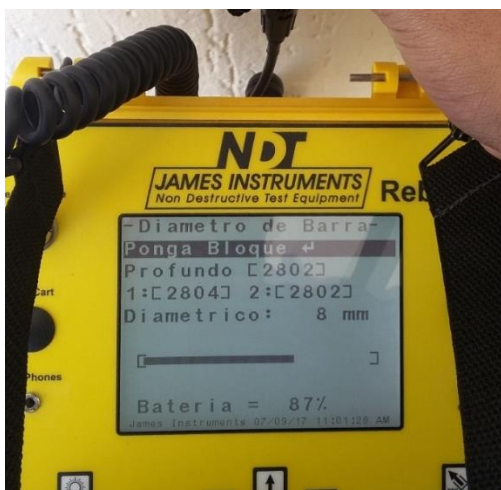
Diámetro de la varilla transversal de una viga perimetral
